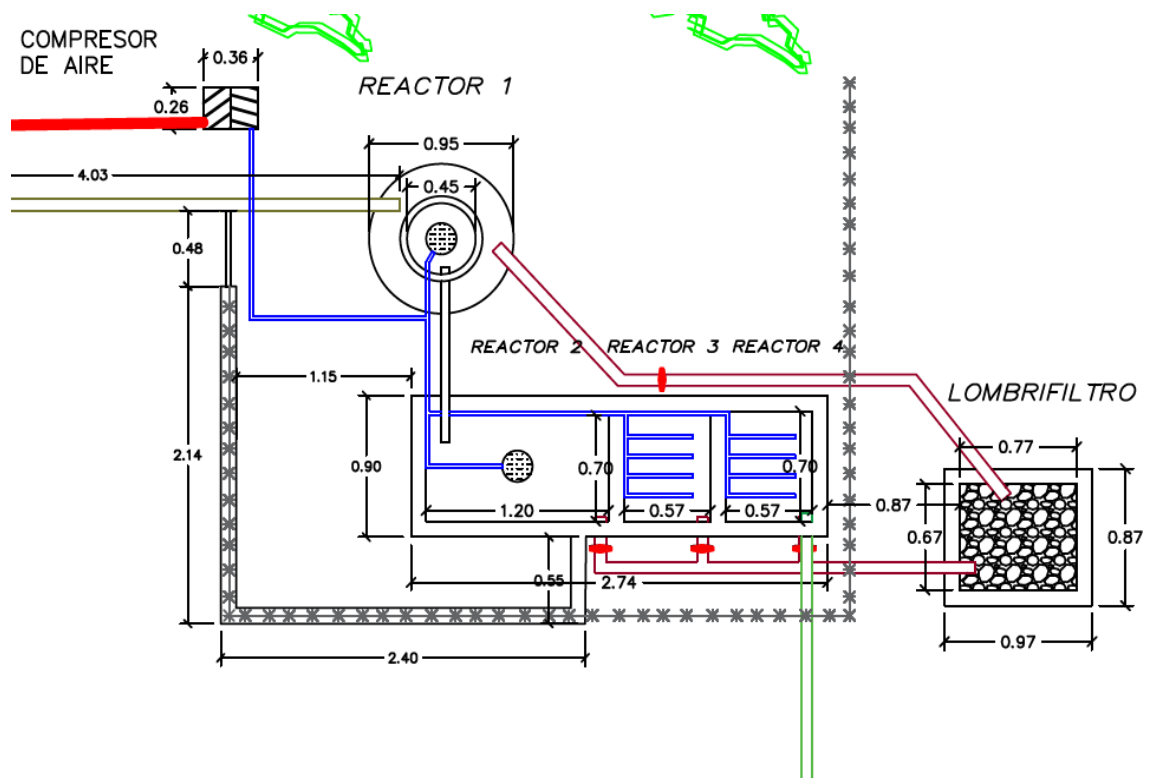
Vista en planta de los biorreactores aerobios continuos a escala piloto
